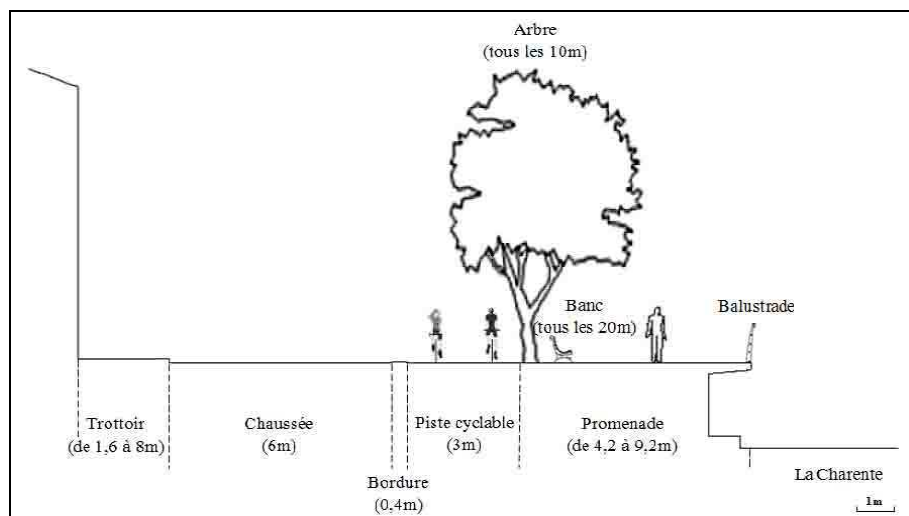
Profil de voirie n°2 - Sans stationnement et avec encorbellement
